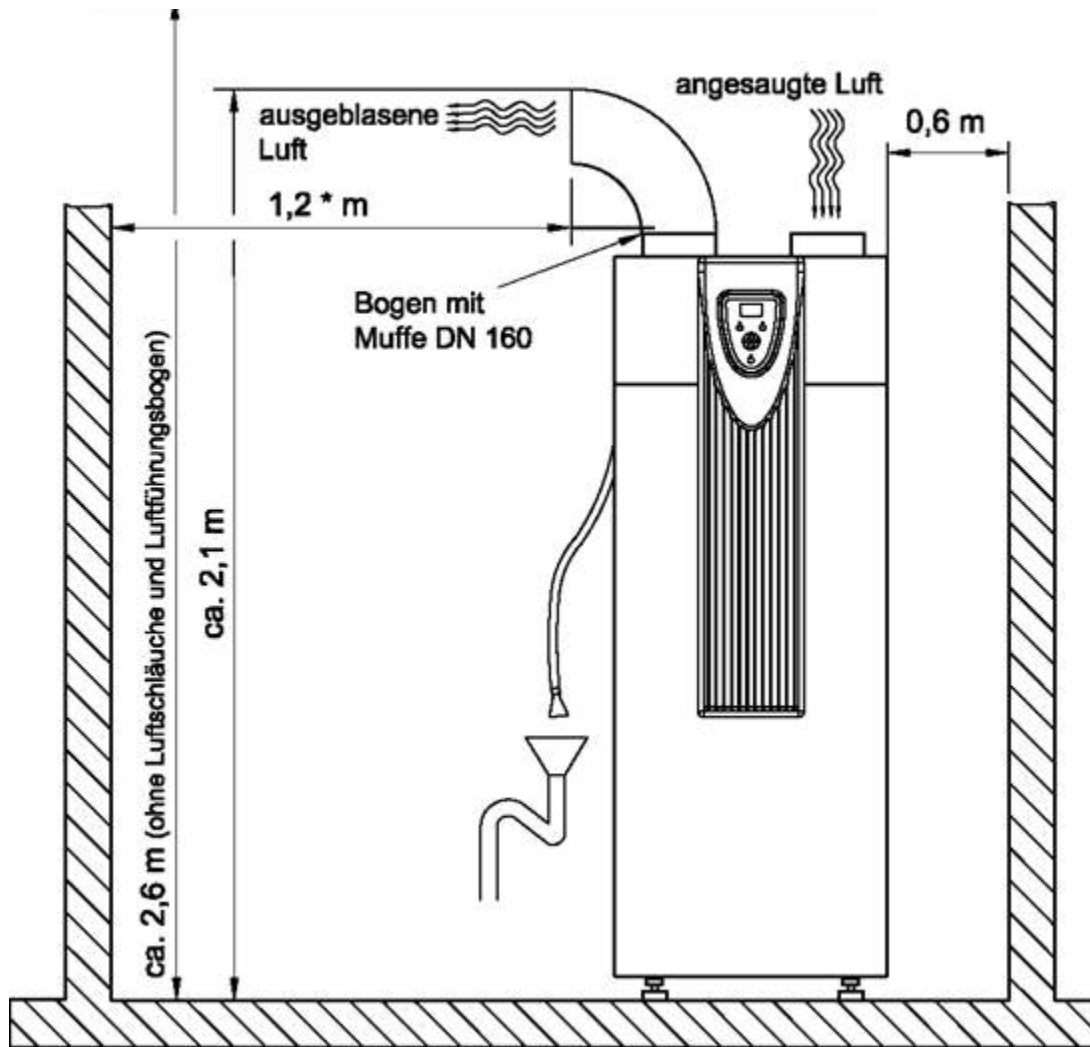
Conditions d'installation pour l'aspiration et le soufflage libres de l'air de process. \*) La distance minimale entre l'ouverture de sortie du conduit d'air et le mur est de 1,2 m
